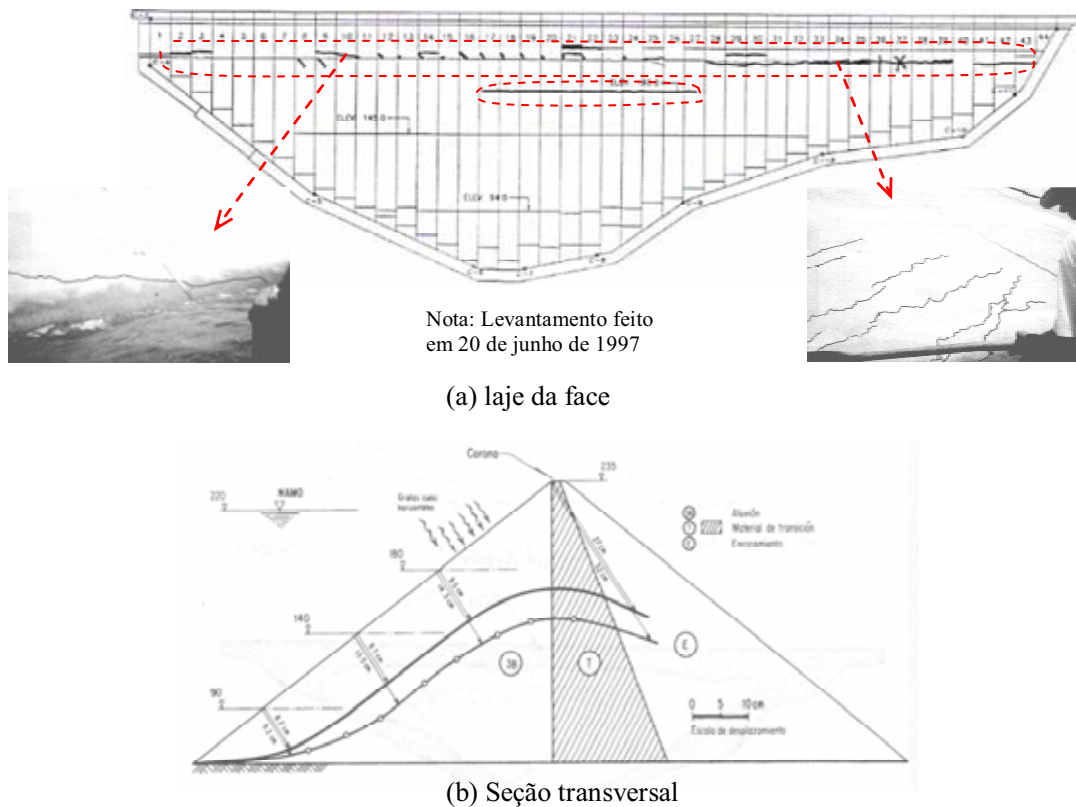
Barragem Aguamilpa (187 m): trincas observadas nas lajes de concreto (Mori, 1999).
